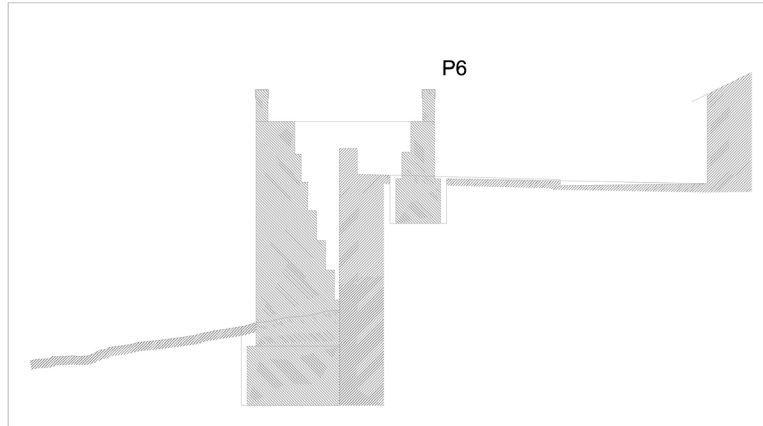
Perfil 6 del Plano de perfiles de la rampa de acceso a la carretera (parte nº 10).
